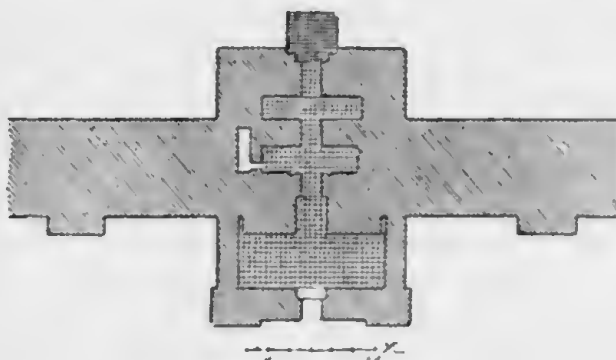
Plan d'une porte de Khorsabad (d'après Place, pl. 18).
